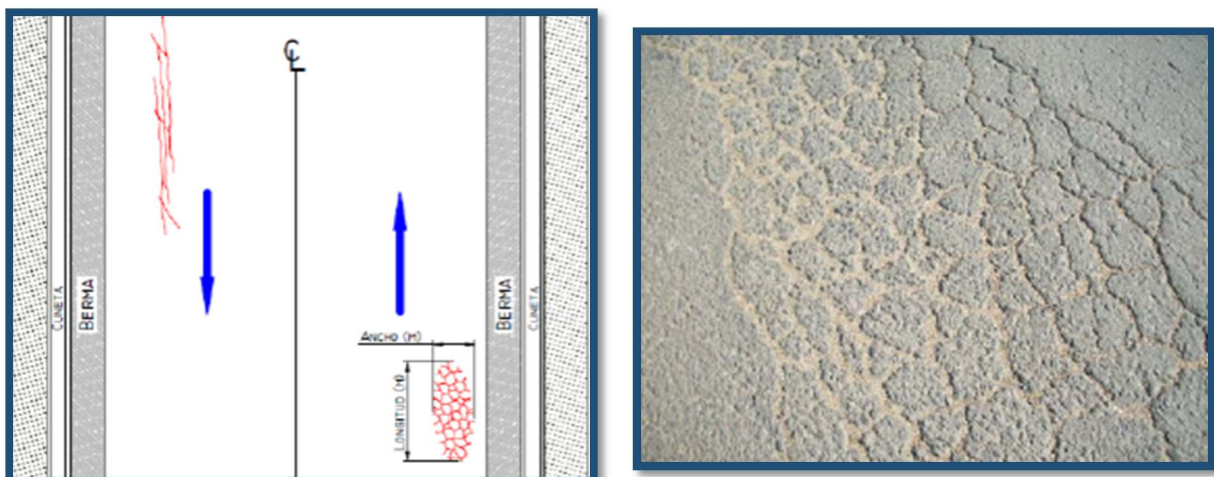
Piel de cocodrilo sobre pavimento asfáltico existente.
